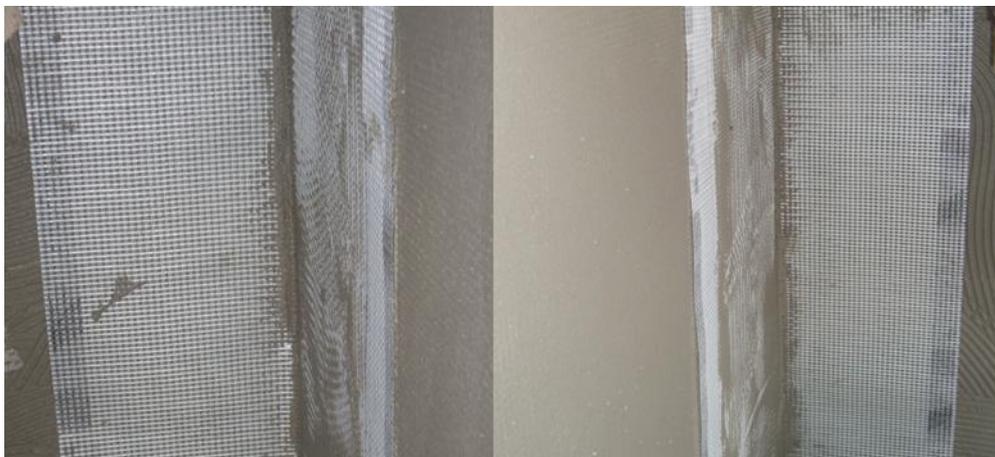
Colocação da armadura em cantos interiores (dobra superior a 10 cm)
